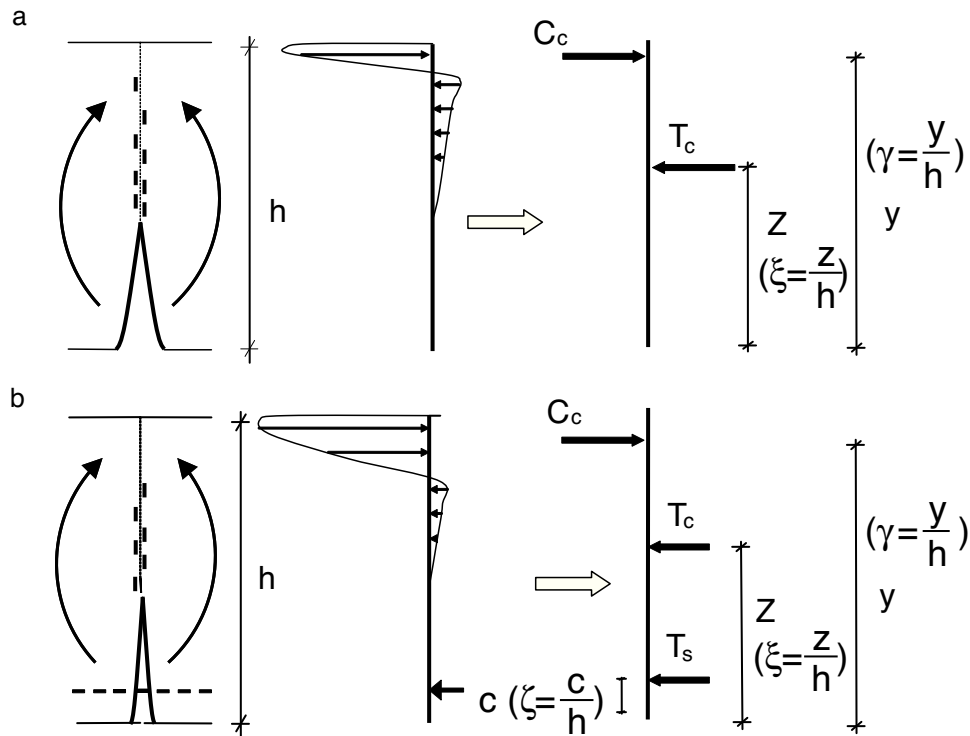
Comportamiento de una sección fisurada a flexión: a) sección sin armadura; b) sección con armadura.
